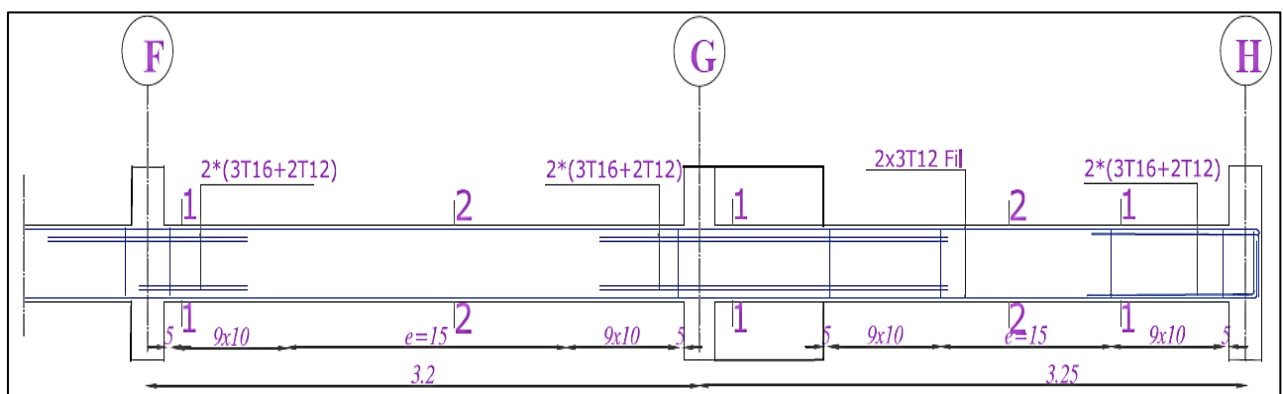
Schéma de ferrailage d'une poutre principale –la plus sollicitée–
